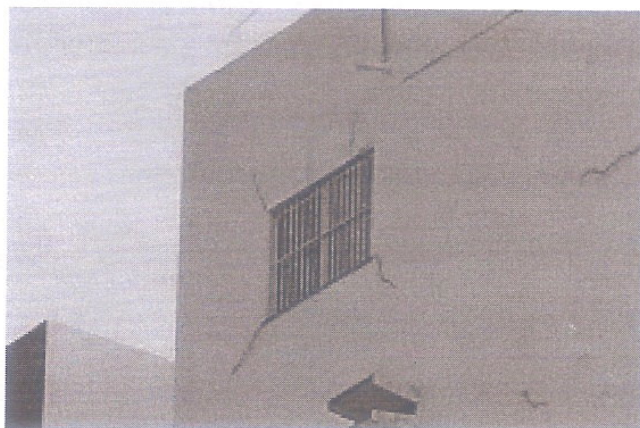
Fissuras causadas devido a aberturas de janelas [4].
